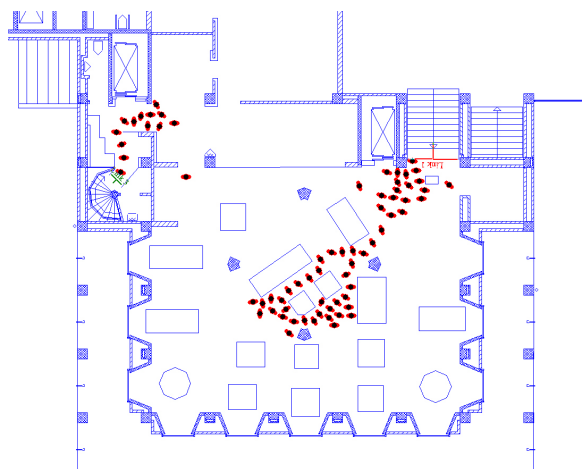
Utrymningsvägar från restaurangen, plan 1
